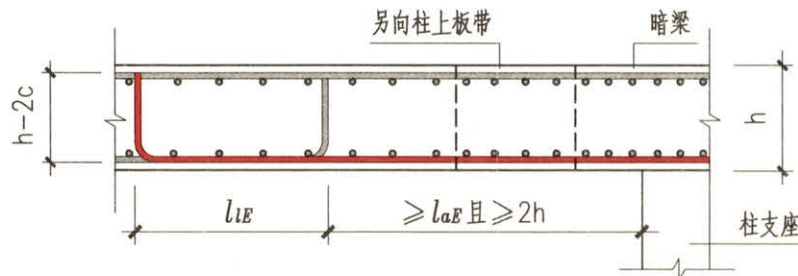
柱上板带板底纵筋支座外搭接构造剖面示意图
